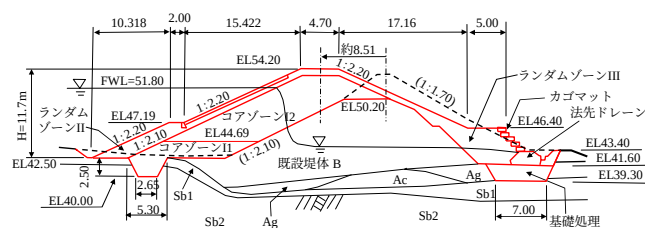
長原口池の改修後堤体の標準断面 (No.3 断面)
